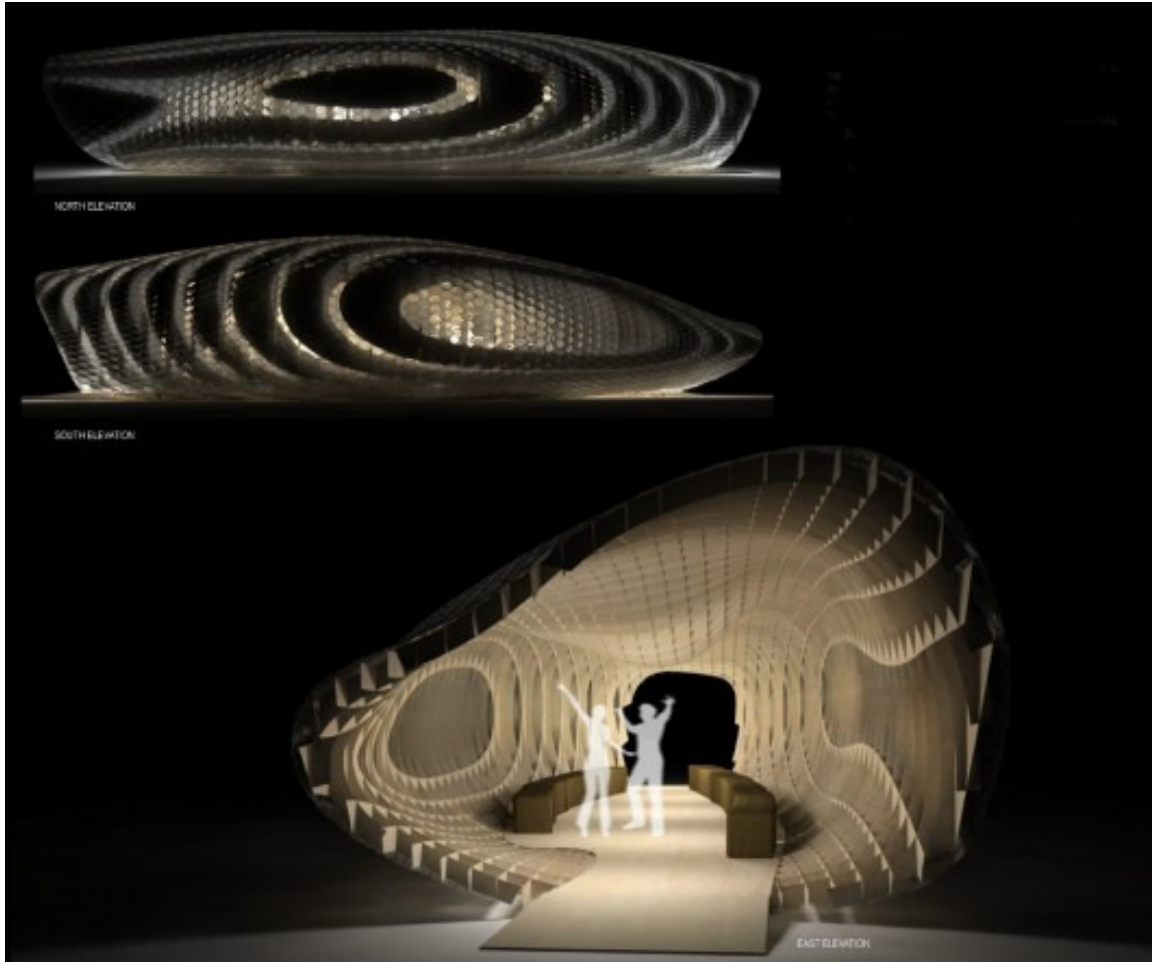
Pavilhão criado para o Art Fund Pavillion Competition 2009 pelo Cre8 Architecture, em Londres.
